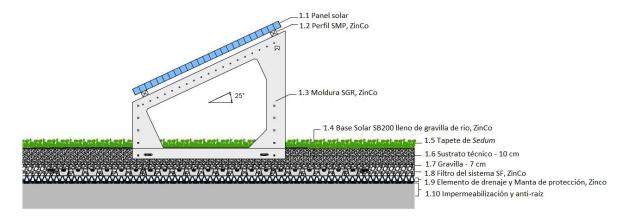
Detalle constructivo mBiGBioSol. Fuente: Proyecto básico y de ejecución EB1 Falcão
